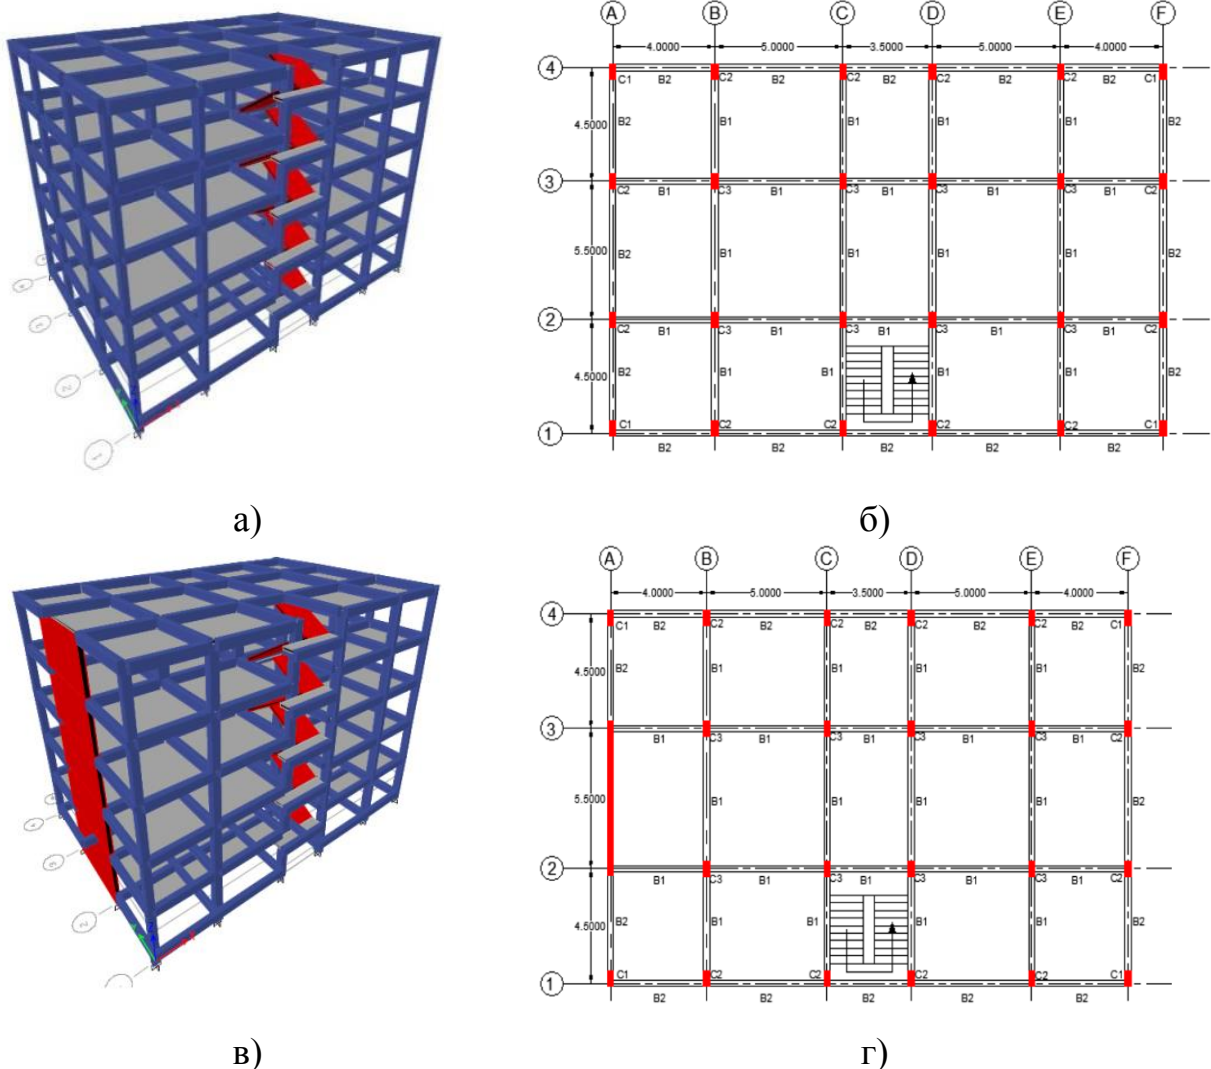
Загальний вигляд та план 5-ти поверхової залізобетонної будівлі – об’єкту досліджень [30]:
